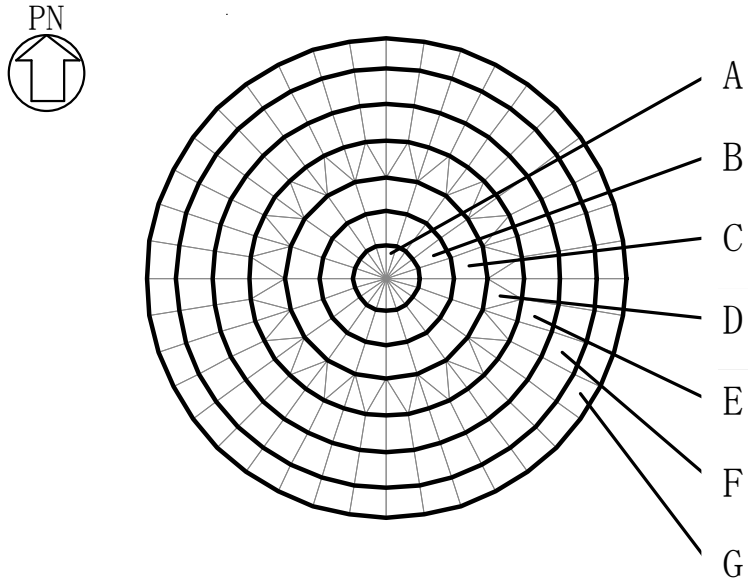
原子炉格納容器底部コンクリートマットの配筋領域
